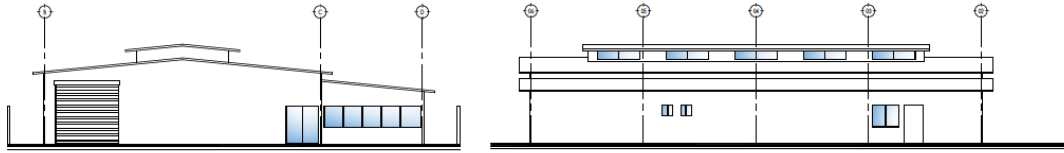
Plano Fachadas de Anteproyecto. *Elaboración Propia TDU. Ver Anexo 15.
